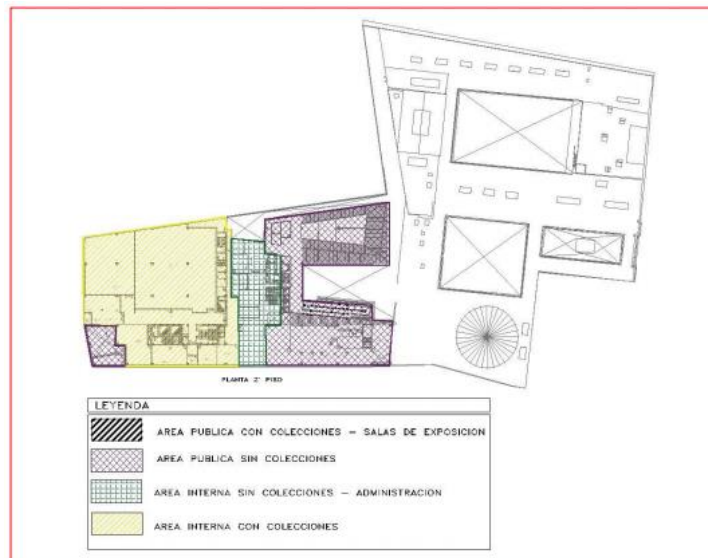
Planta 2do Piso. Fuente: Equipo consultor.
